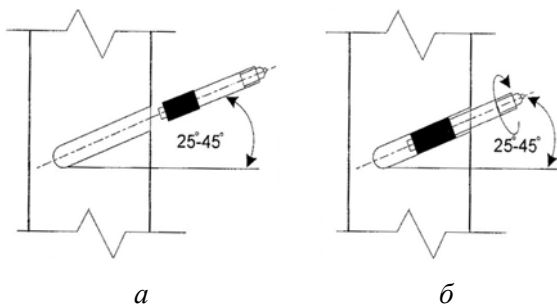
Схема монтажу розтискуючих пакерів: а – установка пакера в підготовлений шпур; б – затискання пакера в шпурі
